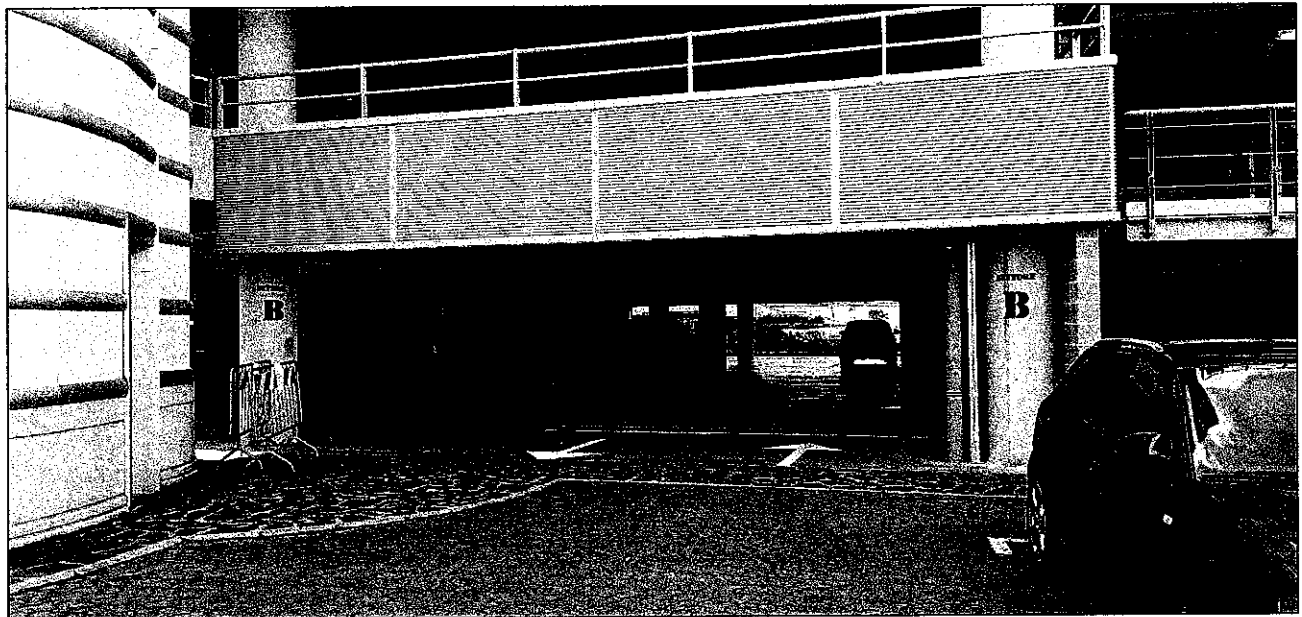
Fabbricato "L4B" - Prospetto su area parcheggio
